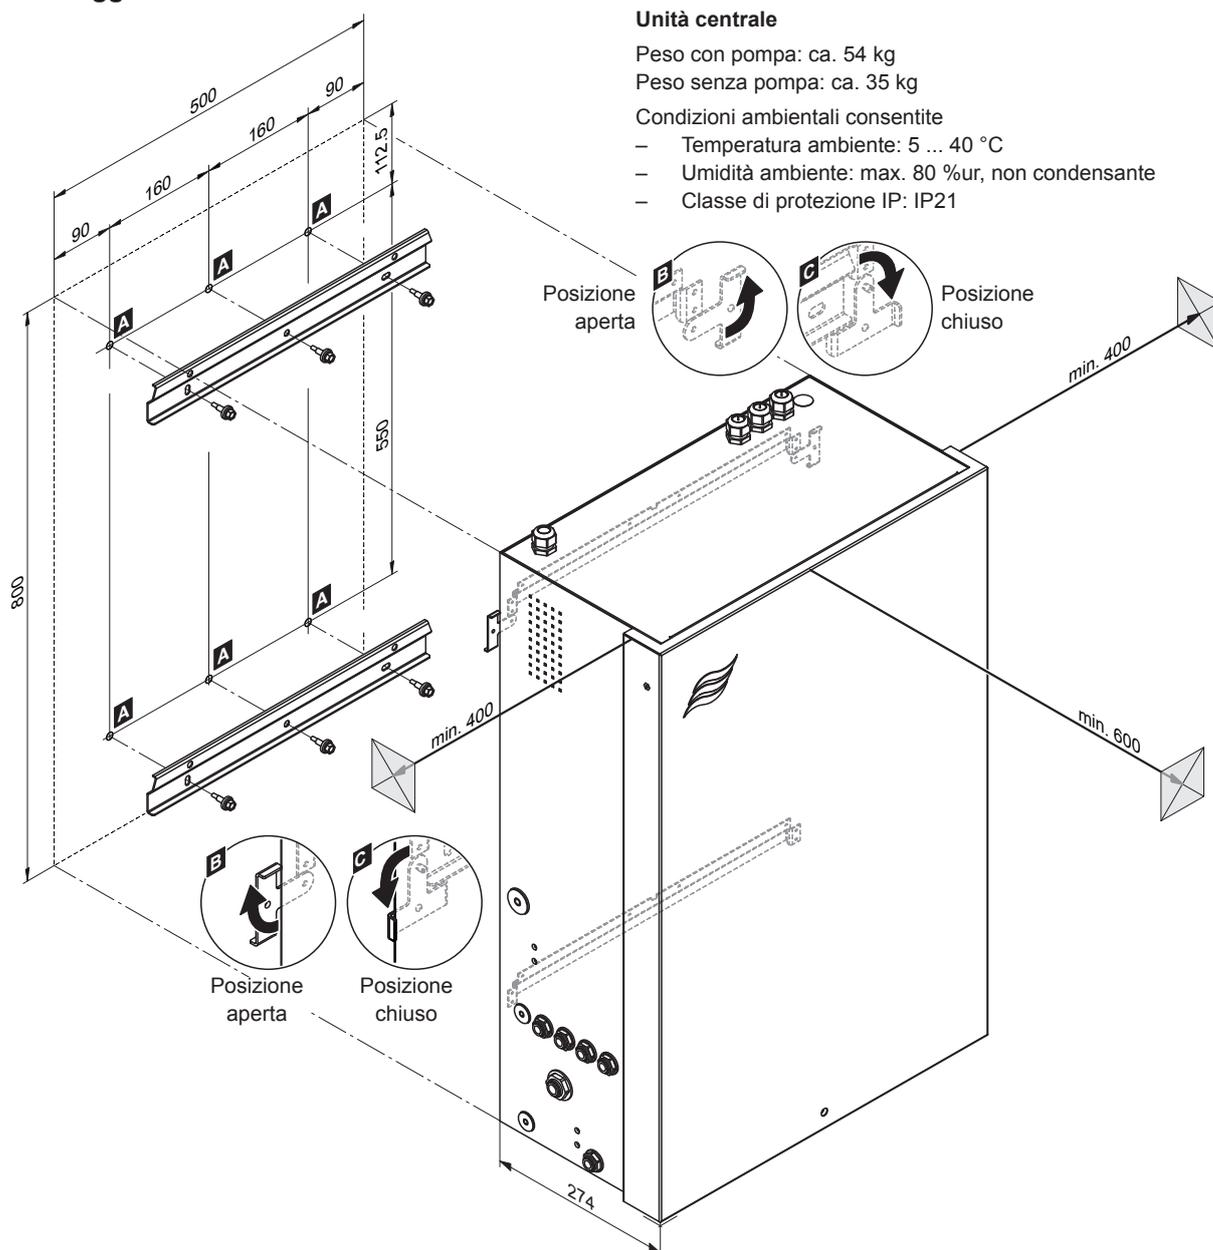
Montaggio dell'unità centrale - dimensioni in mm
